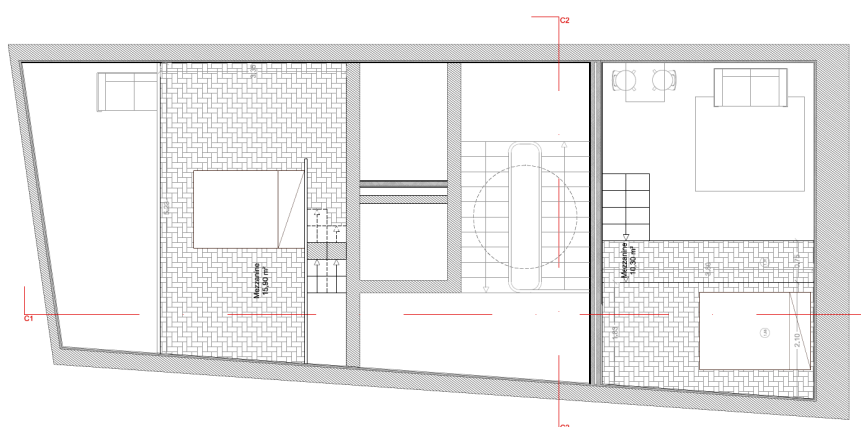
Planta da Mezzanine Piso 3 - Vila Mouzinho
